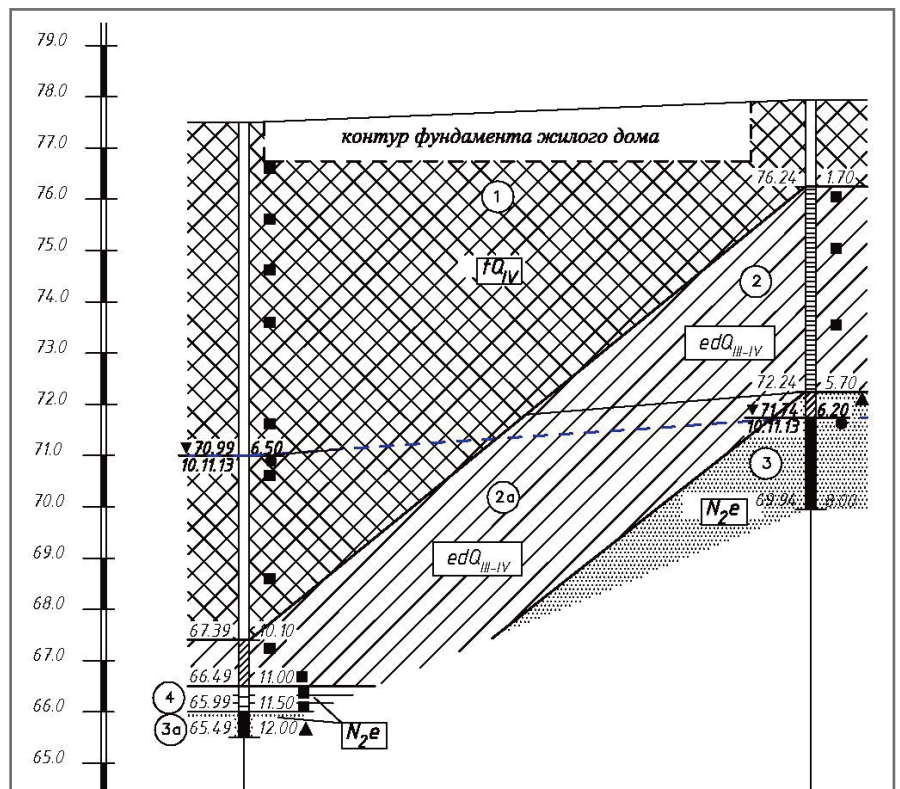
Инженерно-геологический разрез площадки расположения рассматриваемого дома (цифрой 1 в кружке отмечен инженерно-геологический элемент, сложенный насыпными грунтами)
